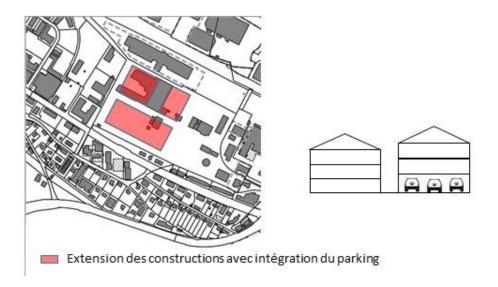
densification d'une parcelle partiellement construite (selon les règles du plan d'affectation)
